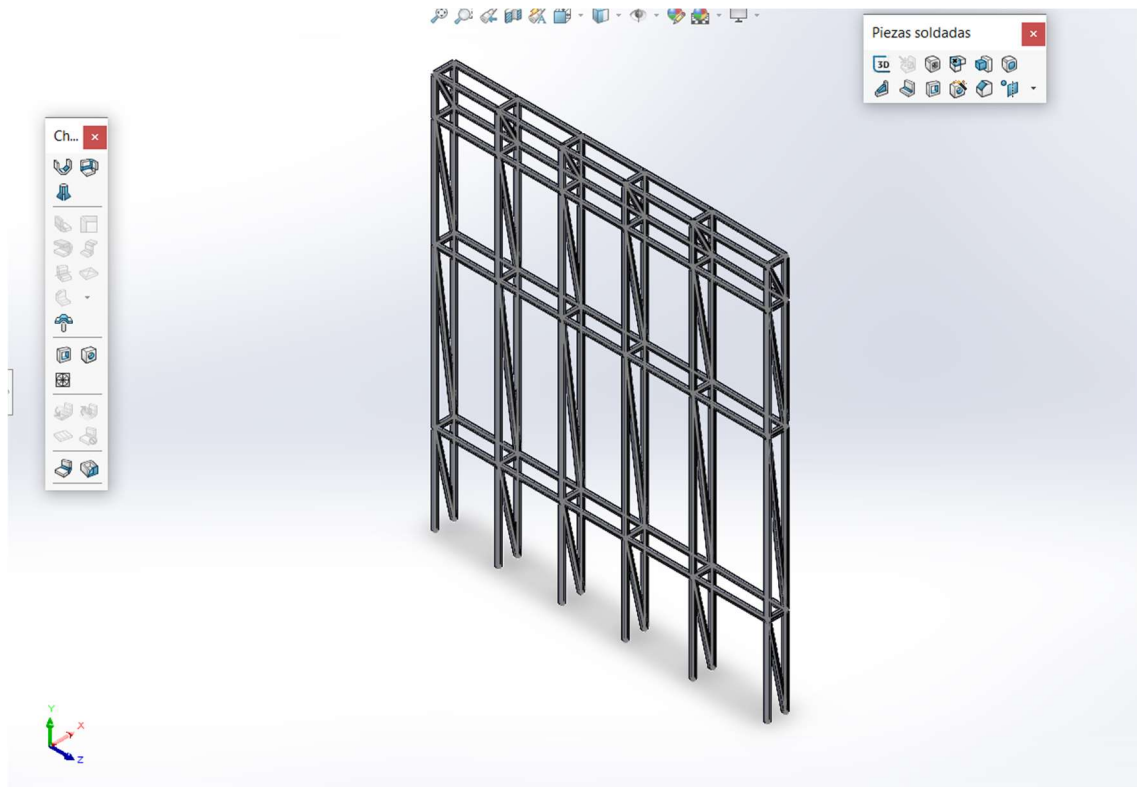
, Modelizado en 3D de la estructura metálica de la fachada derecha (SOLIDWORKS)
